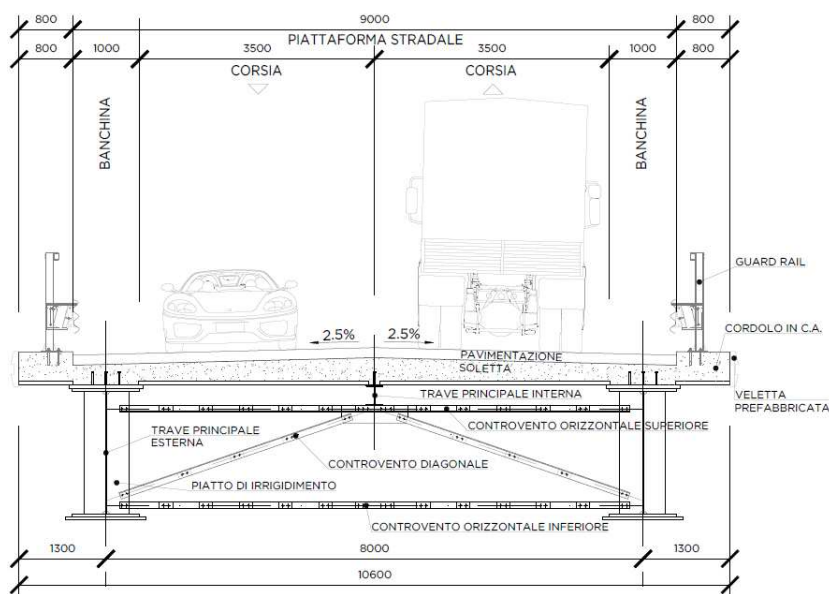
Proposta n°3 - Sezione ponte nuovo
